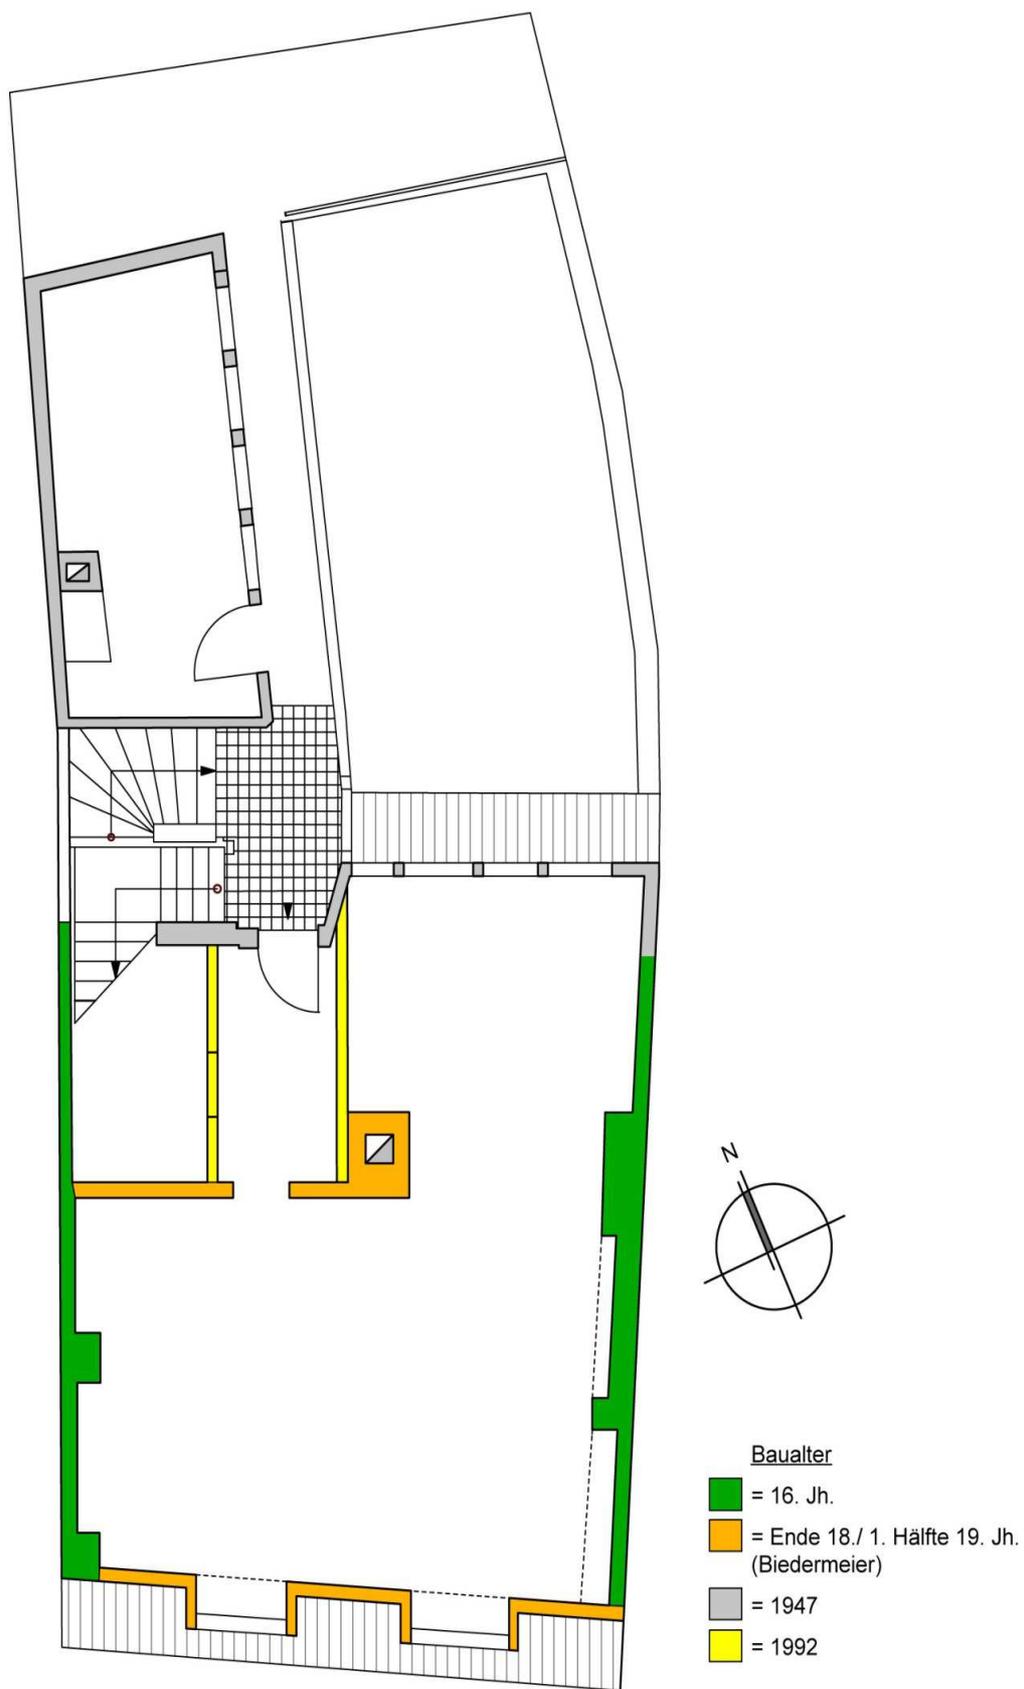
Hohlweg 4, Baualtersplan Erdgeschoss
